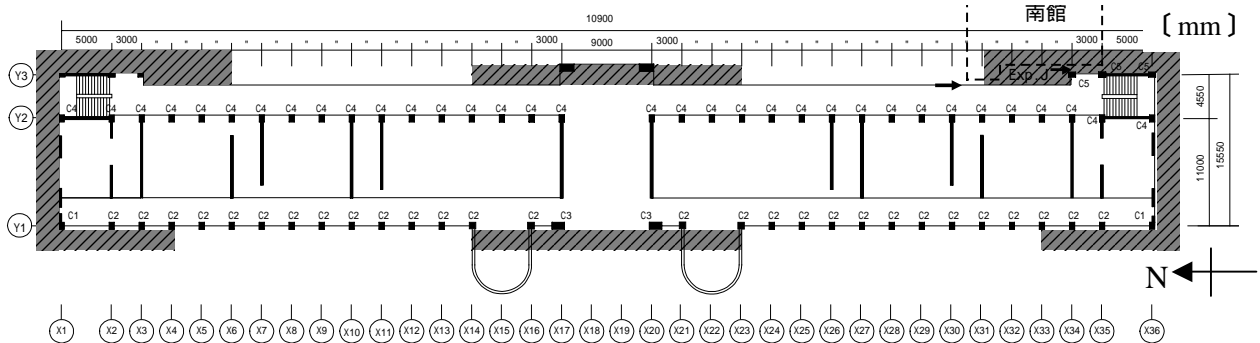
虎山国民小学校本館1階平面図と壁の損傷度  RC壁
